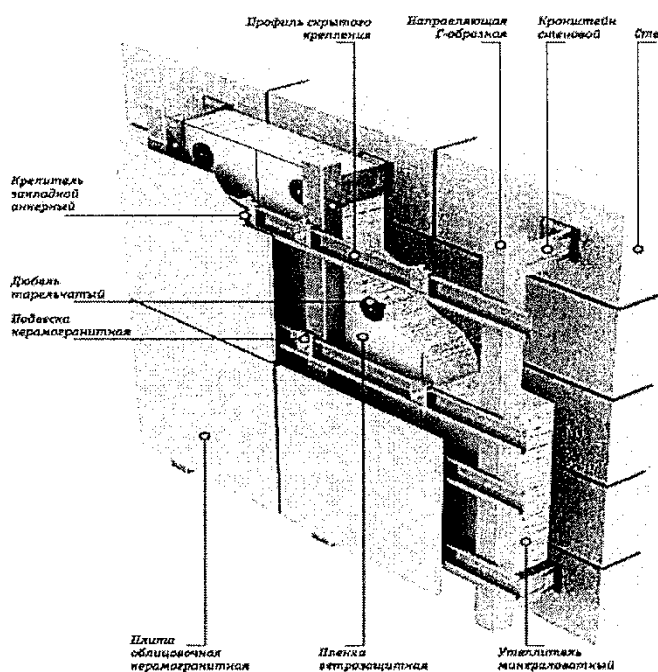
Схема отделки фасада керамогранитной облицовочной плиткой
